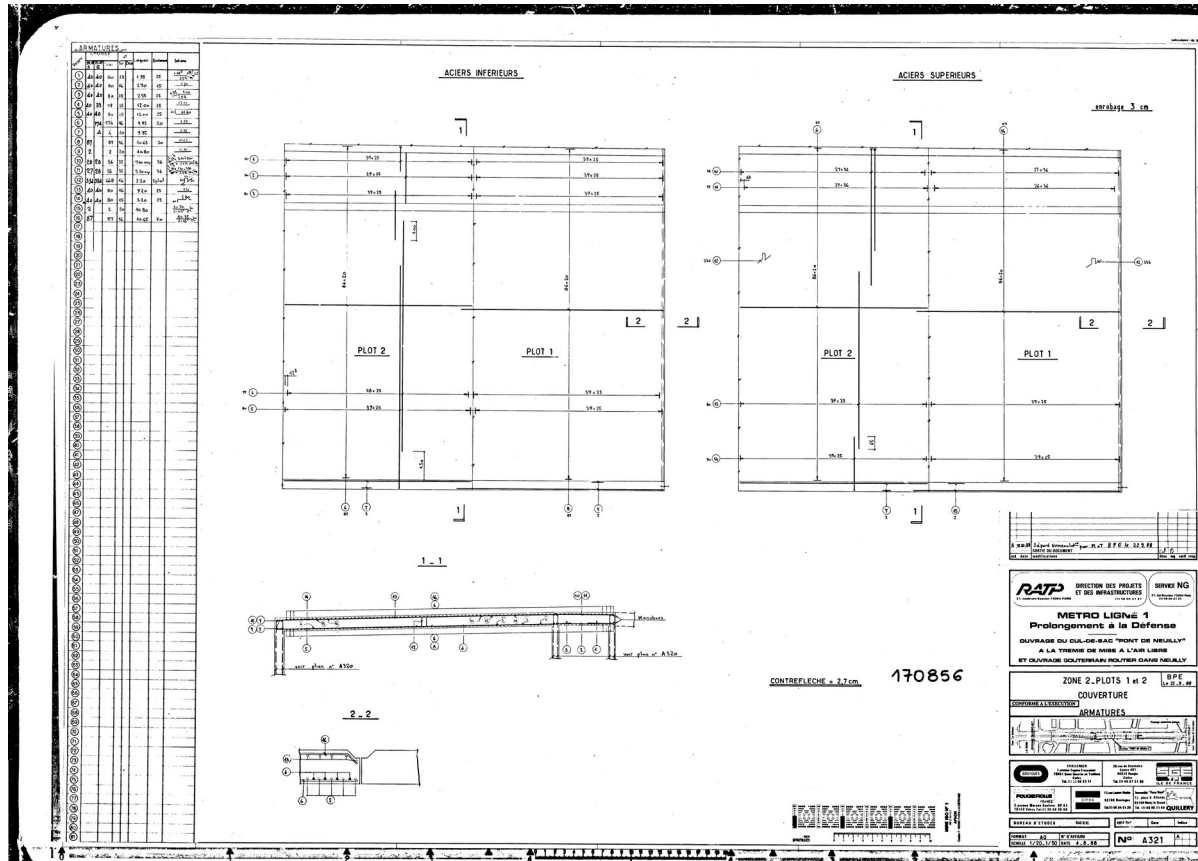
Ferrailage traverses 1 et 2\_plan 170856
